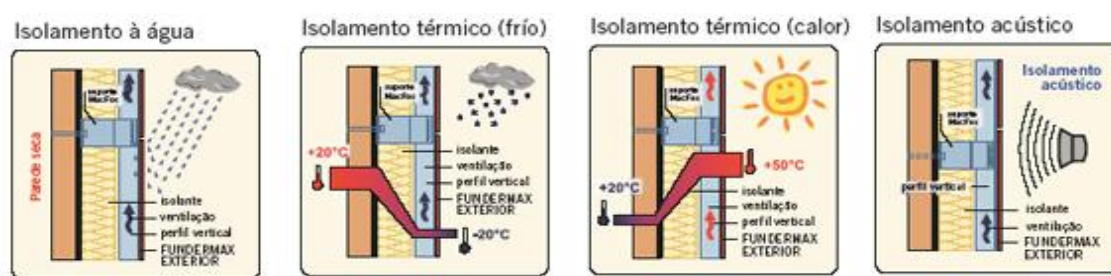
Exemplo ilustrativo da fachada ventilada com aplicação do fundermax
